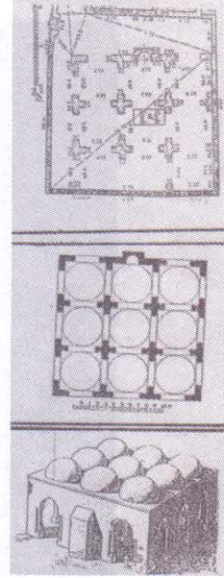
، القباب ( ٣١ - ٣٨ ) ، مسقط أفقي ( عمل الباحث )
